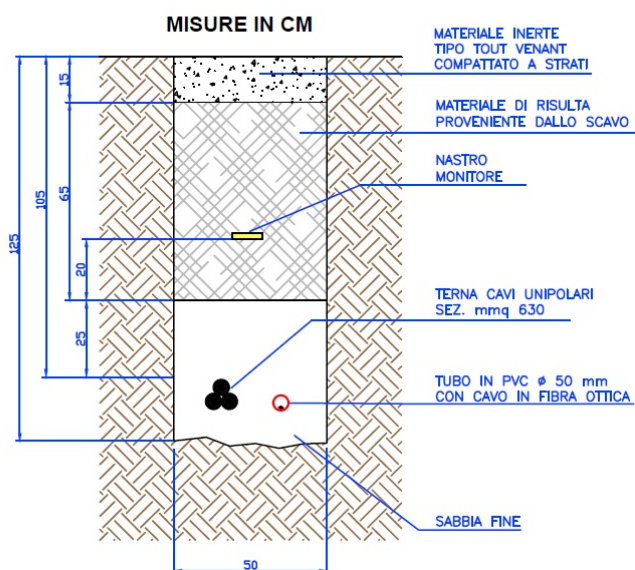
Sezione tipo cavidotto con terna di cavi unipolari su strada sterrata intraparco
